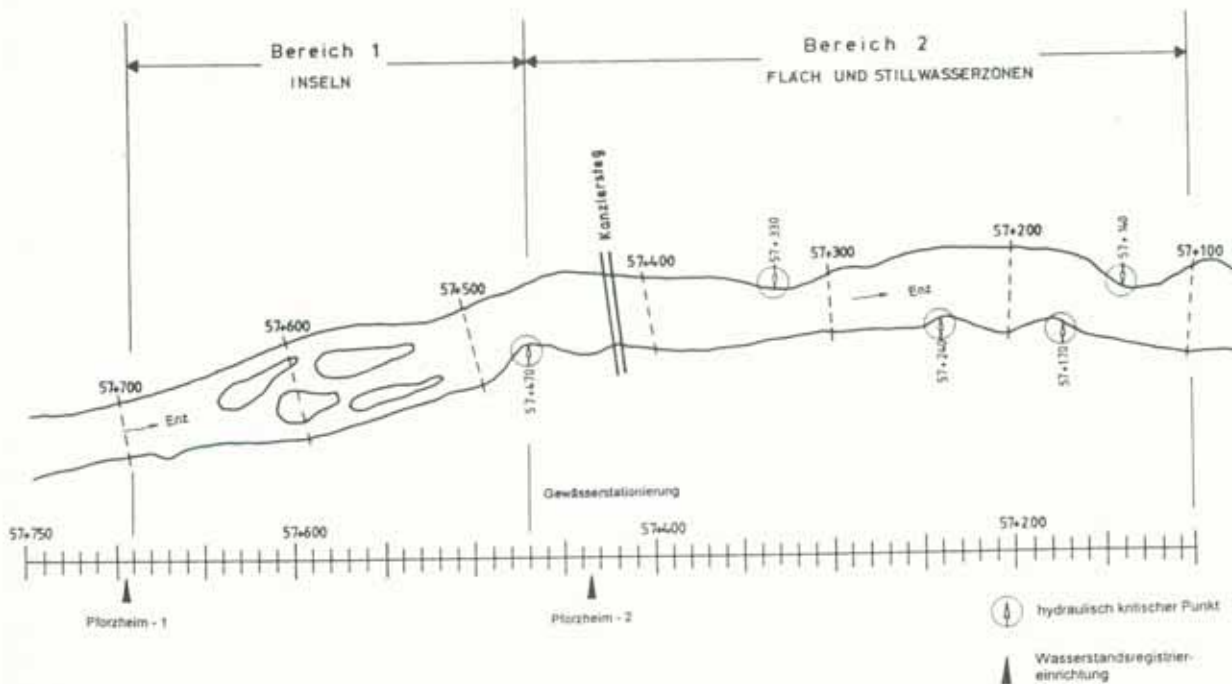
Übersichtslageplan der Umgestaltungsstrecke mit den hydraulisch kritischen Punkten.
